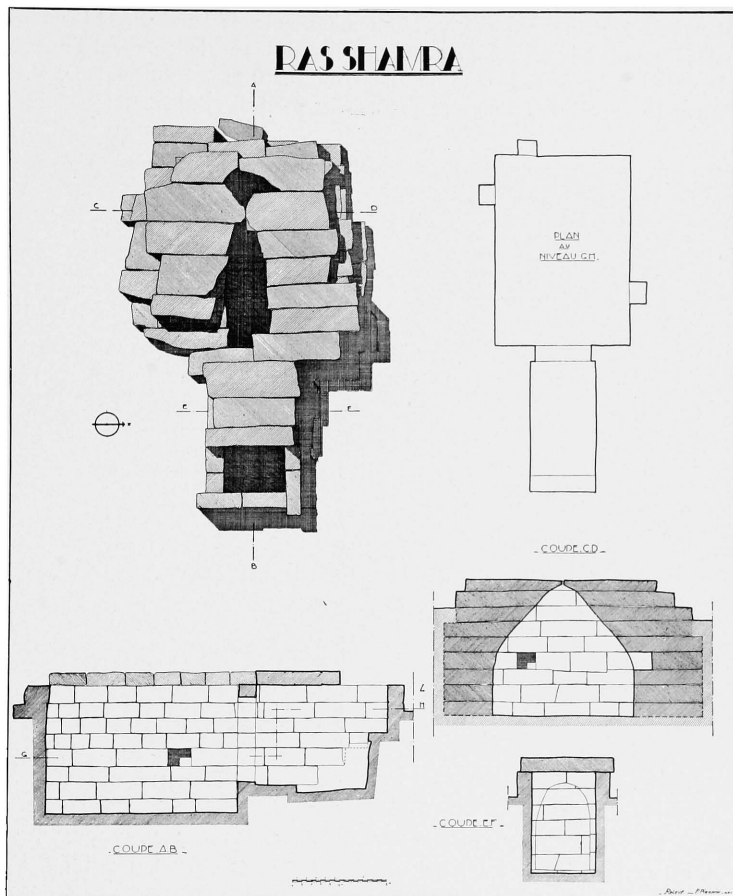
Plan et coupes du caveau XXXI (p. 88).
